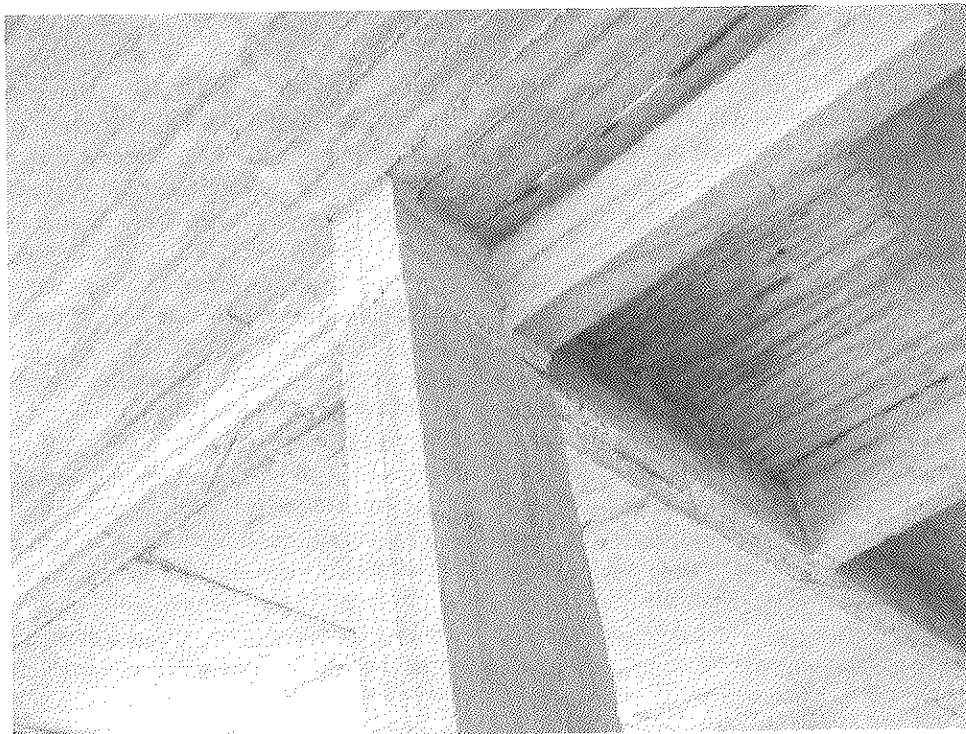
Vigas excéntricas llegando a un pilar y deficiencias de configuración.
